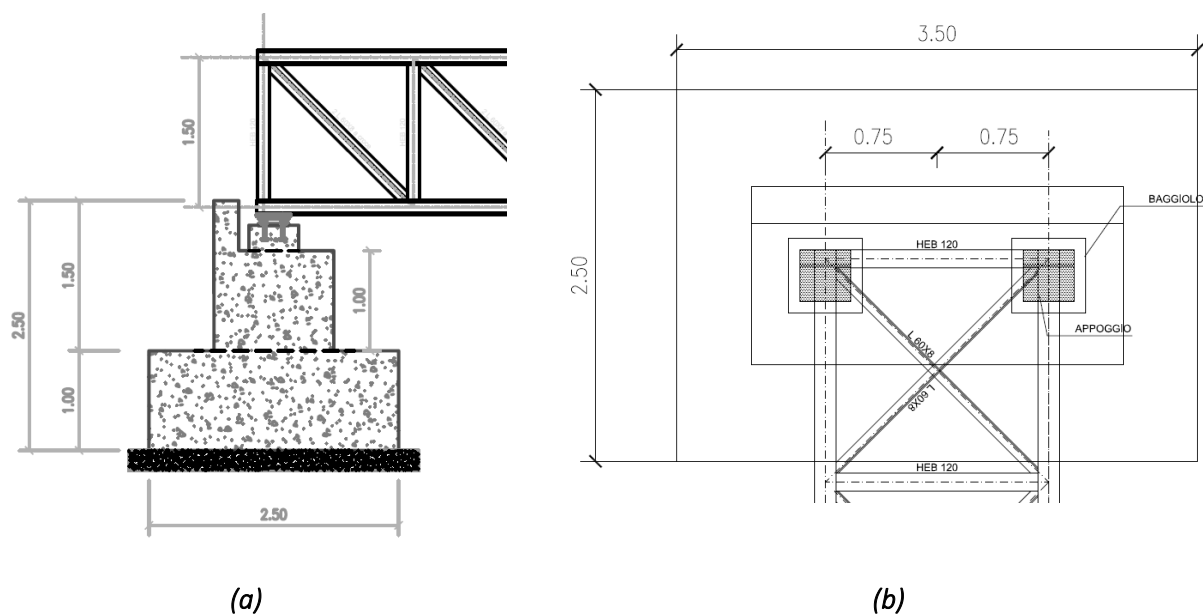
Dettaglio spalla, (a) prospetto, (b) planimetria
